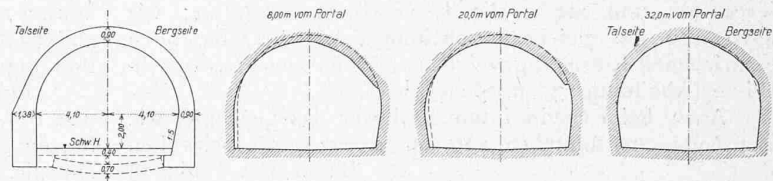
bis 57. Tunnelprofil und Deformationen im Sevistein-Tunnel II. — 1:400.
